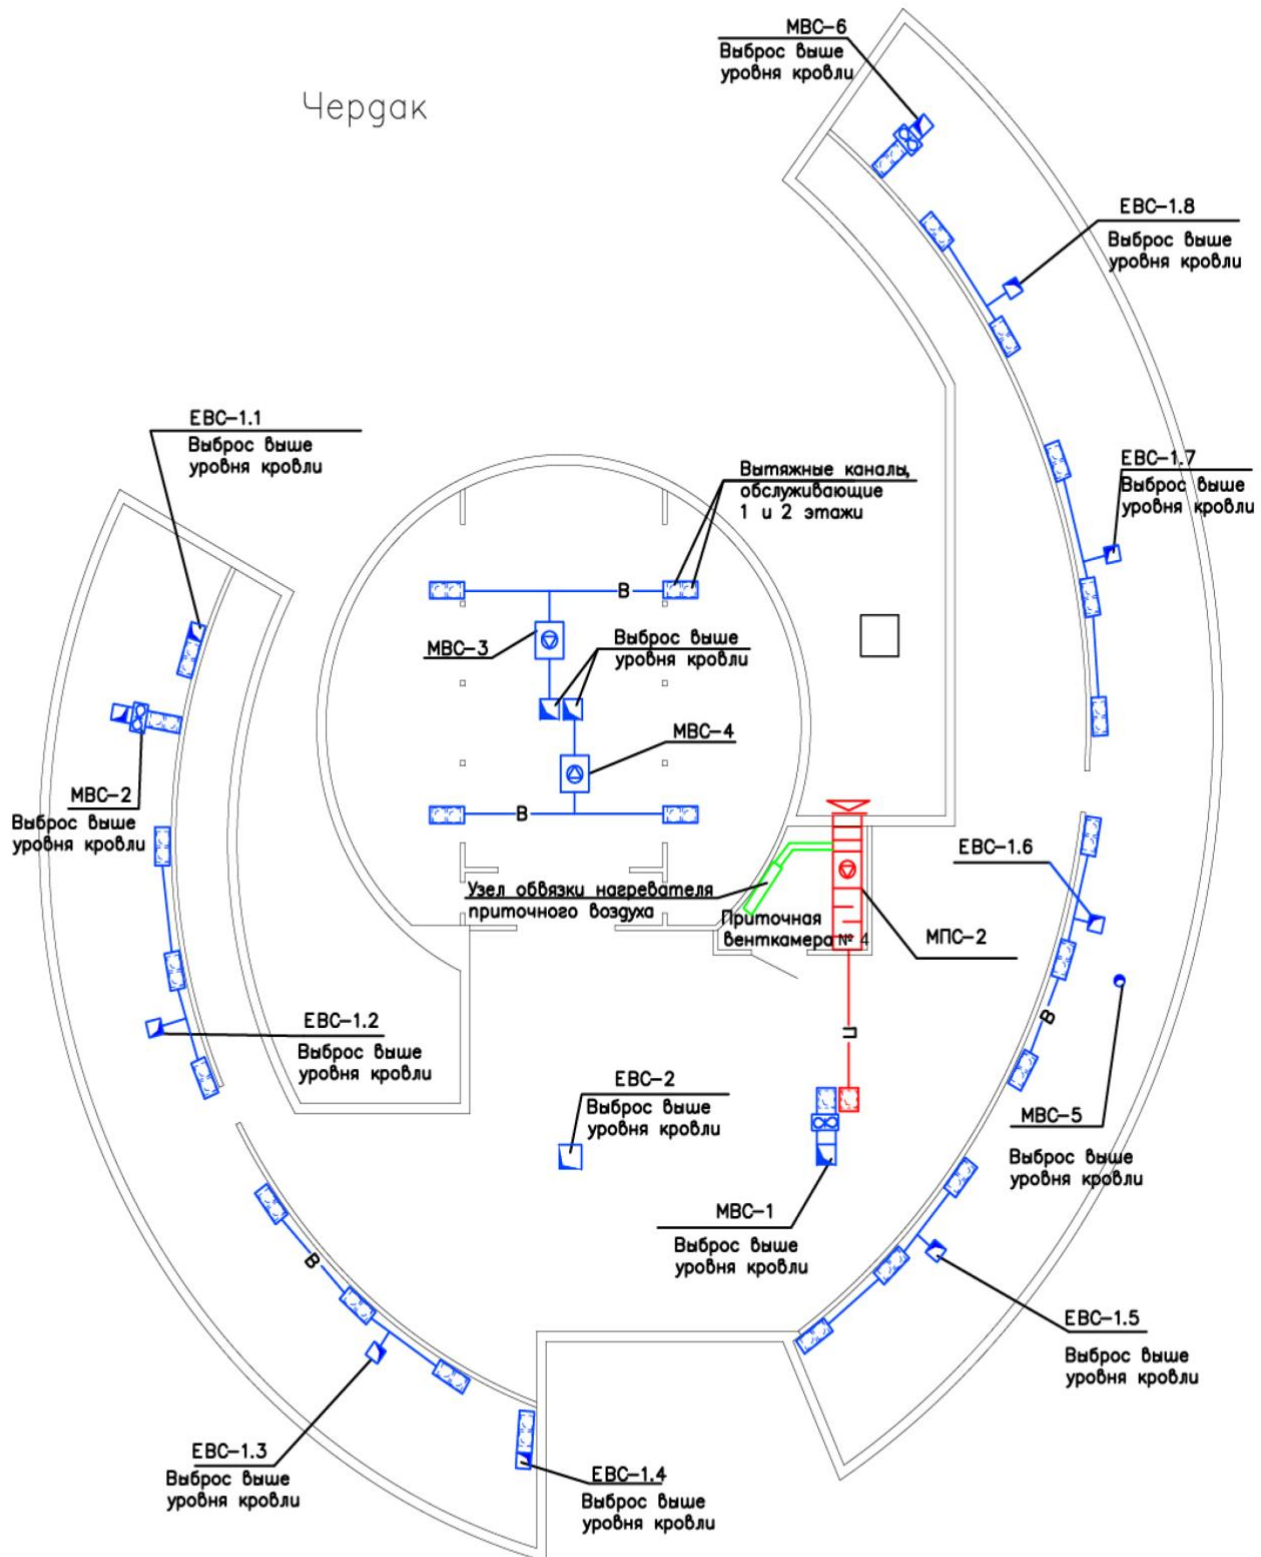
Рисунок V Пример размещения оборудования, воздуховодов и вытяжных шахт систем вентиляции на чердаке здания школы
